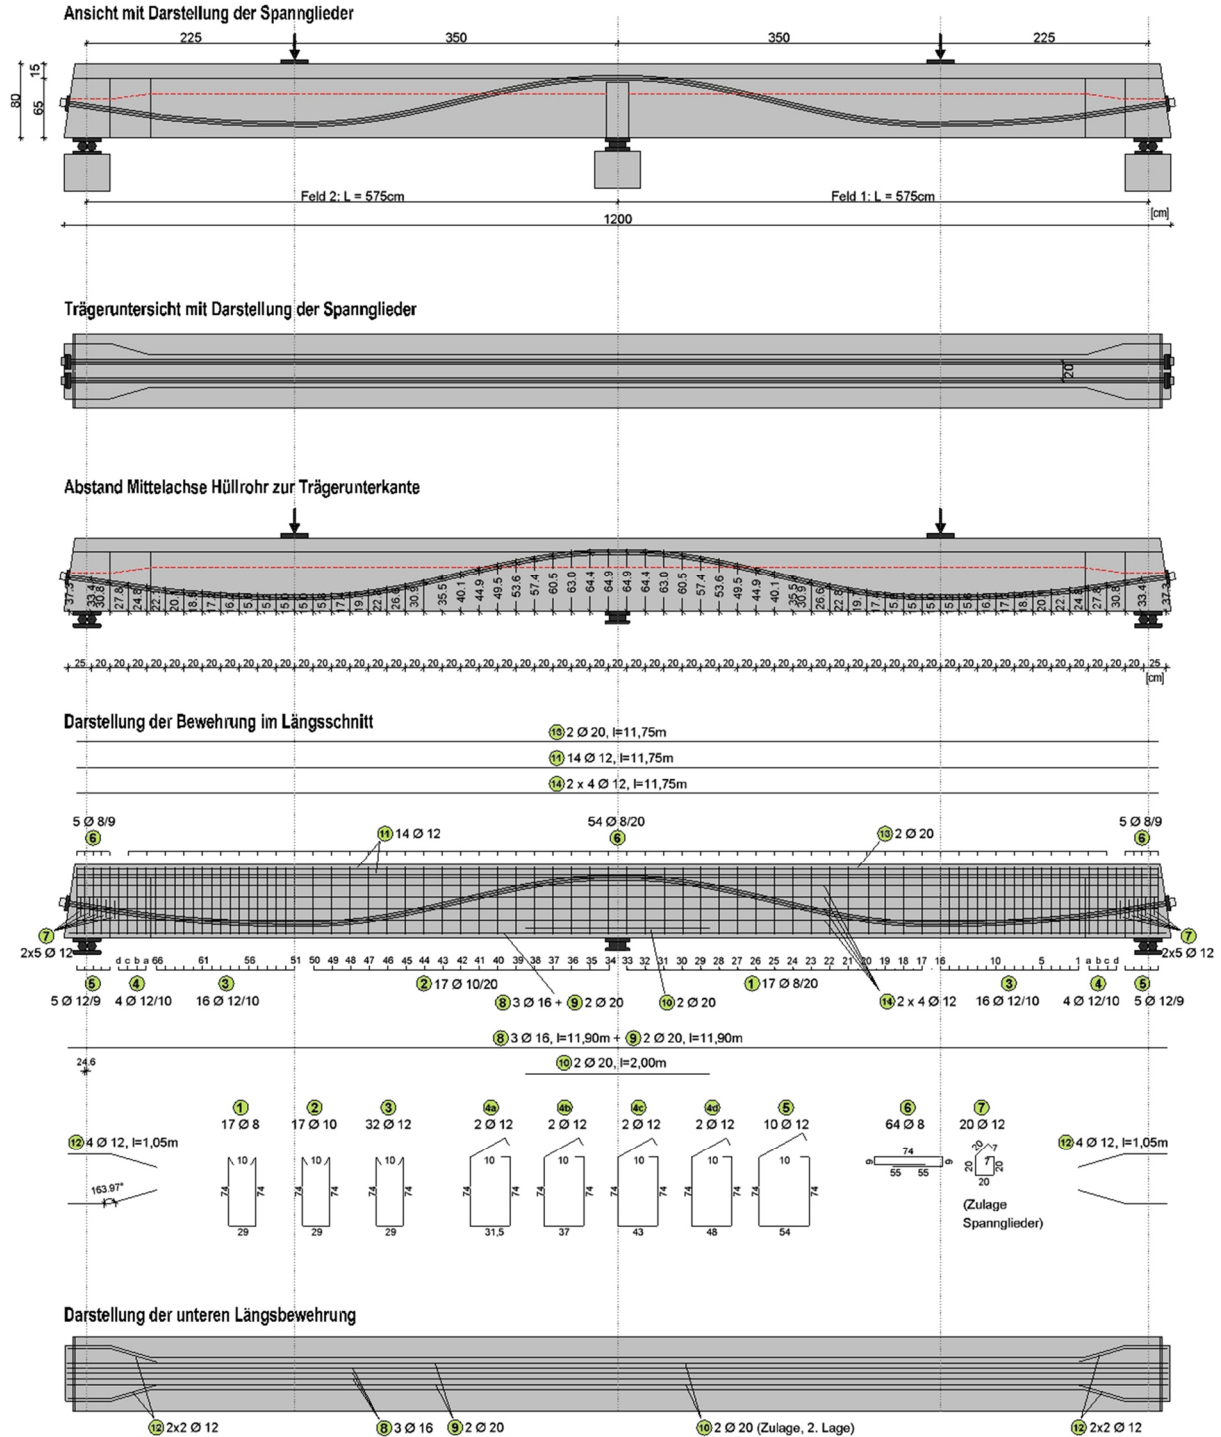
Bewehrungsplan Versuchsträger DLT 5
